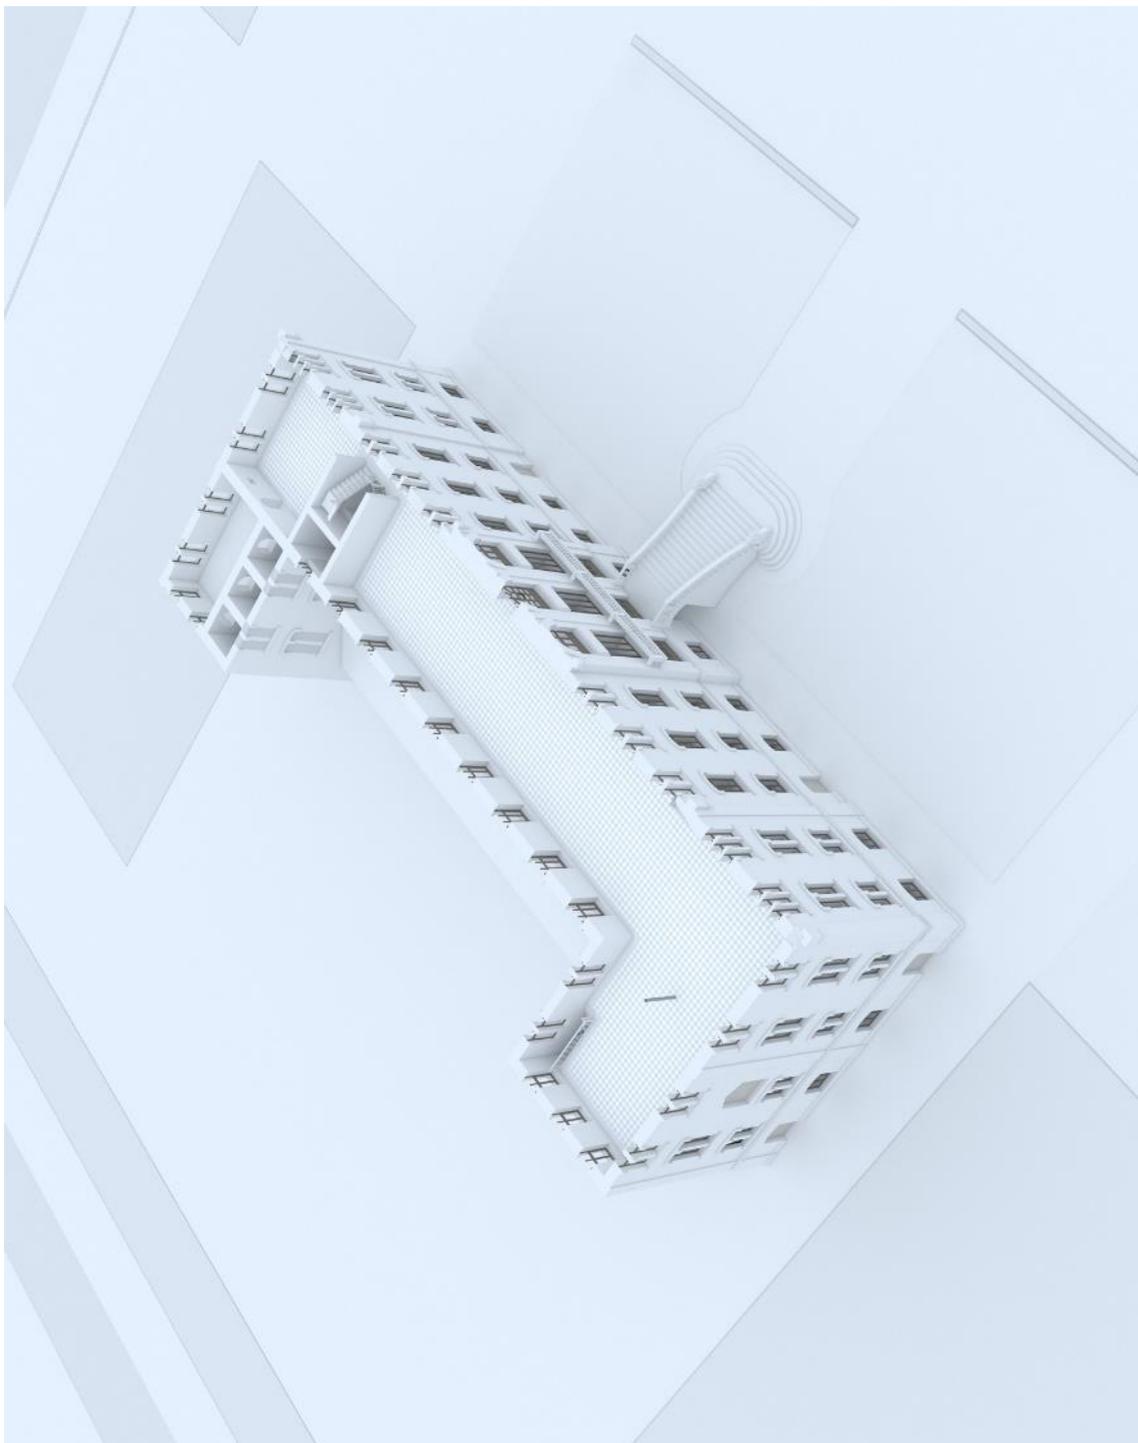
Imagen virtual. La fábrica. Planta tercera. Sección por debajo de la estructura de cubierta.
